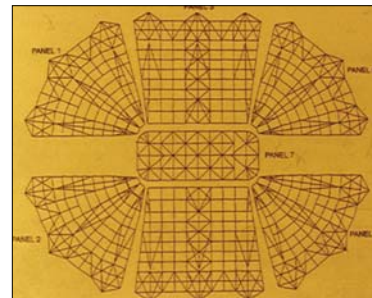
Pierwszy etap montażu dachu nad krytą halą Namihaja Dome, Japonia
